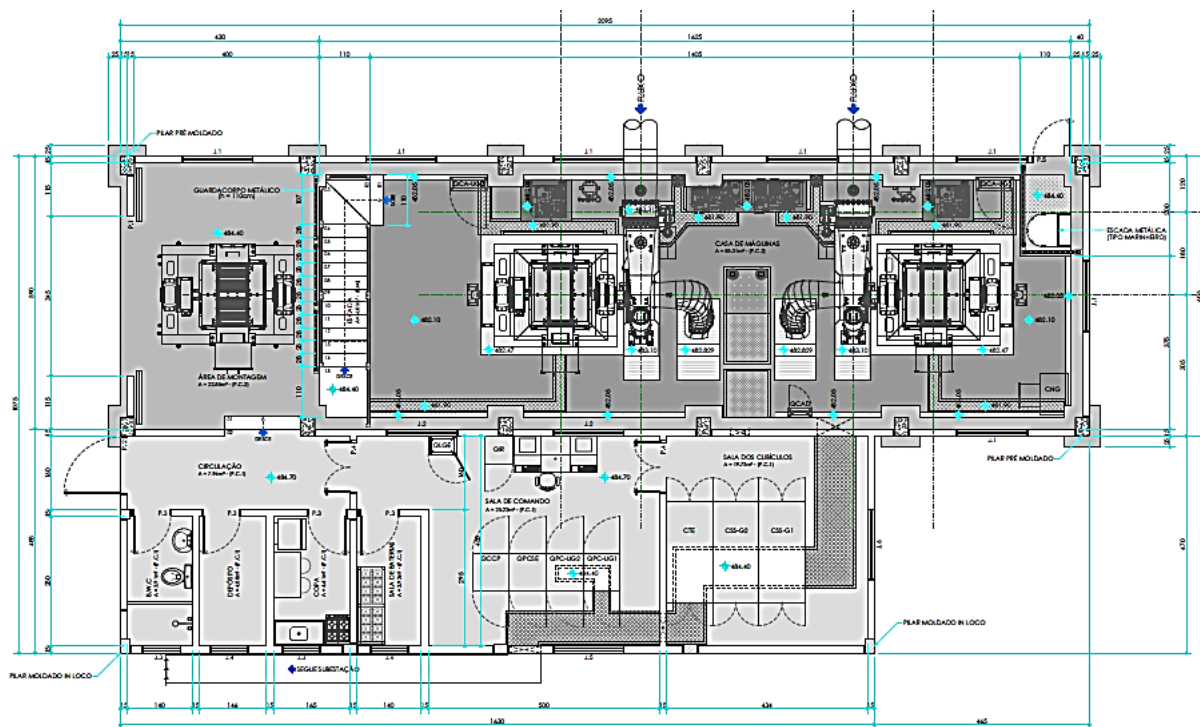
Projeto básico PCH Pito – planta baixa da Casa de Força
